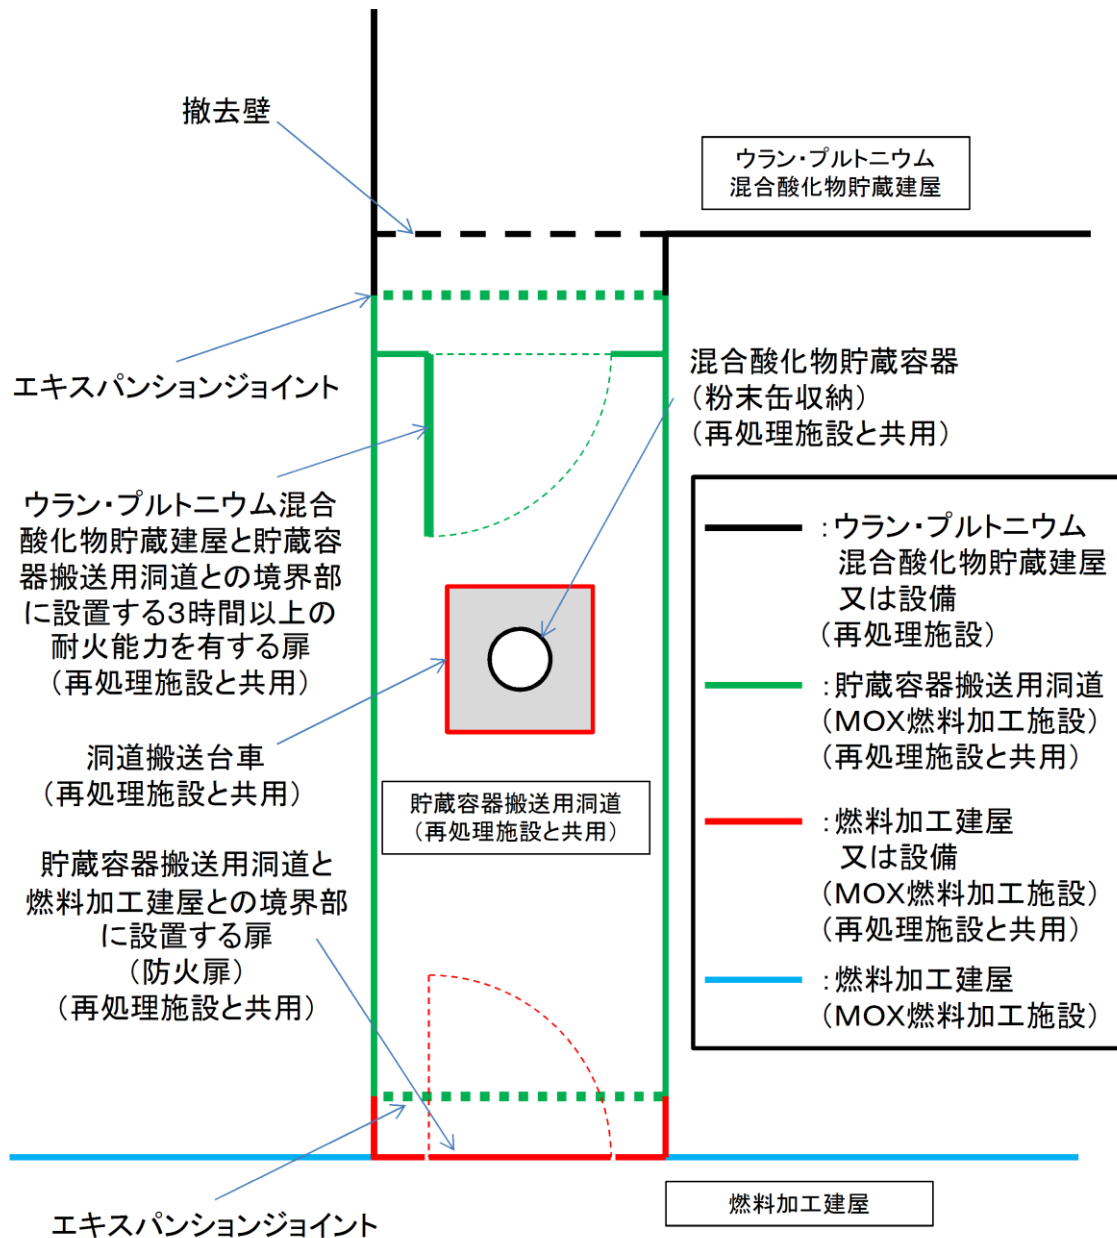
2. 11-1 変更範囲に関する概要図 (平面図)
